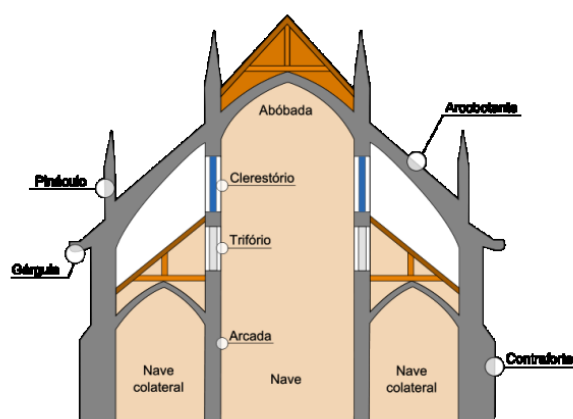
Corte transversal de uma igreja gótica, onde são visíveis as estruturas de madeira¹¹⁴.
